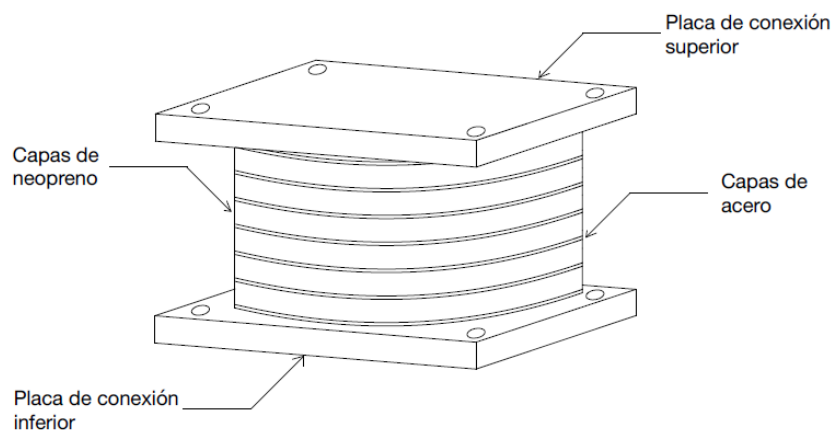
Aislador sísmico de apoyo de neopreno laminado.
